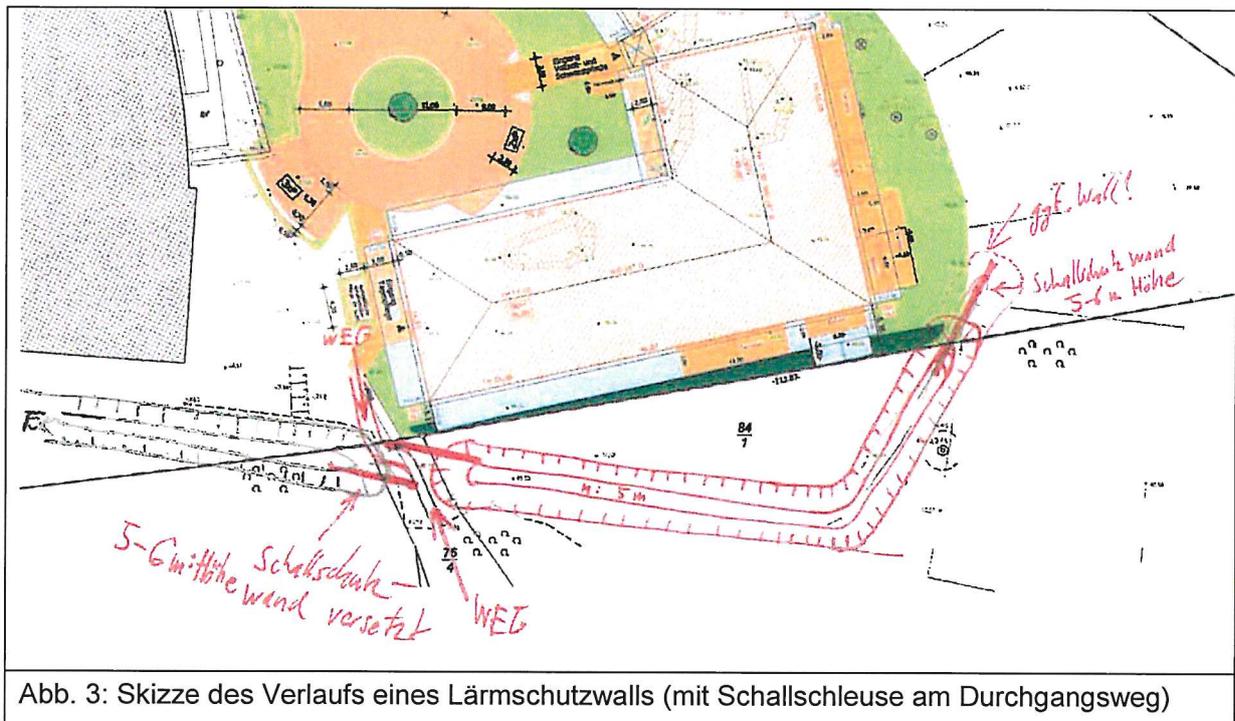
Skizze des Verlaufs eines Lärmschutzwalls (mit Schallschleuse am Durchgangsweg)
